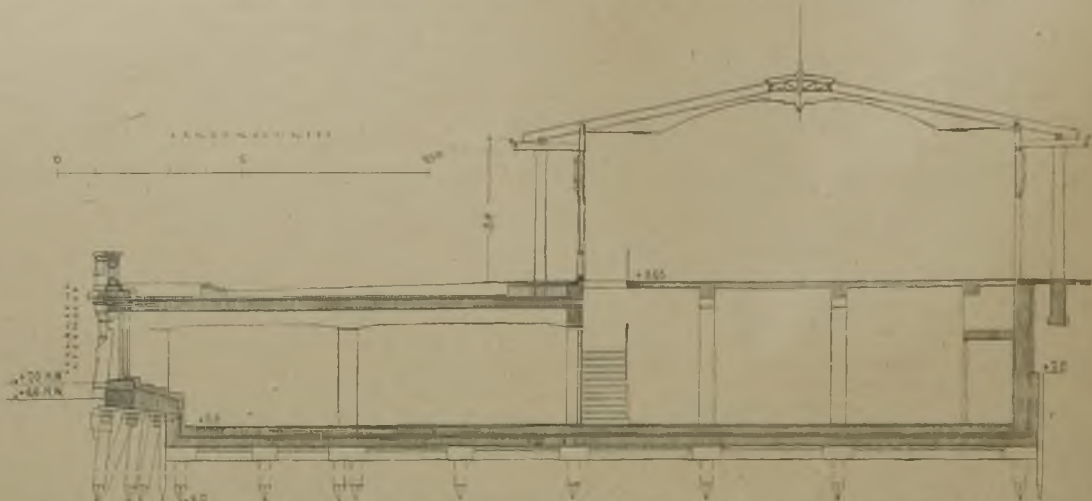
Längsschnitt durch das Untergeschoß mit Schnitt durch den Oberbau.
